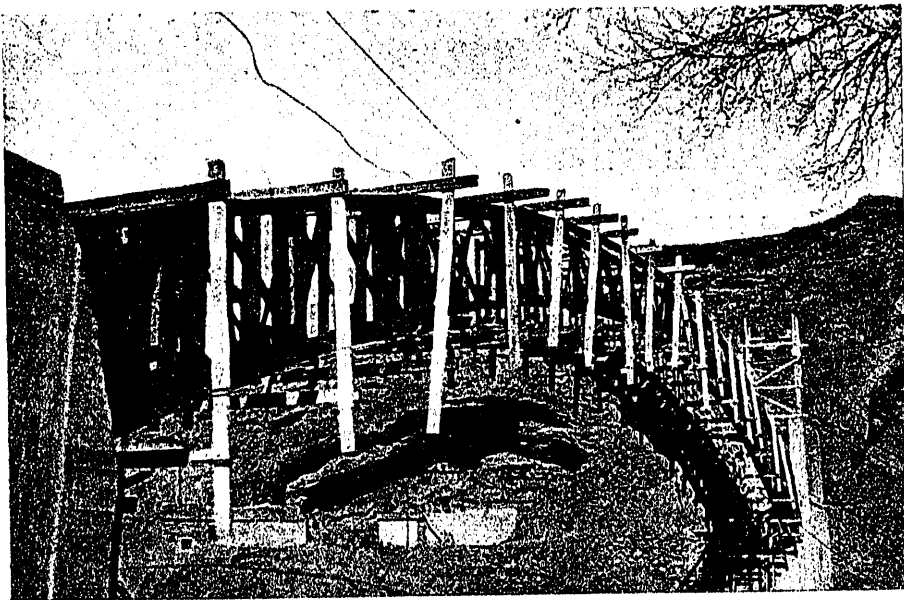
Armaduras rígidas del arco, colocadas, y preparación para el montaje del encofrado
